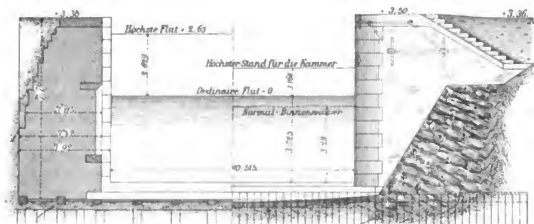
u. 243. Querschnitt einer Kammerschleuse mit hölzernem Boden. M. 1 : 200.
